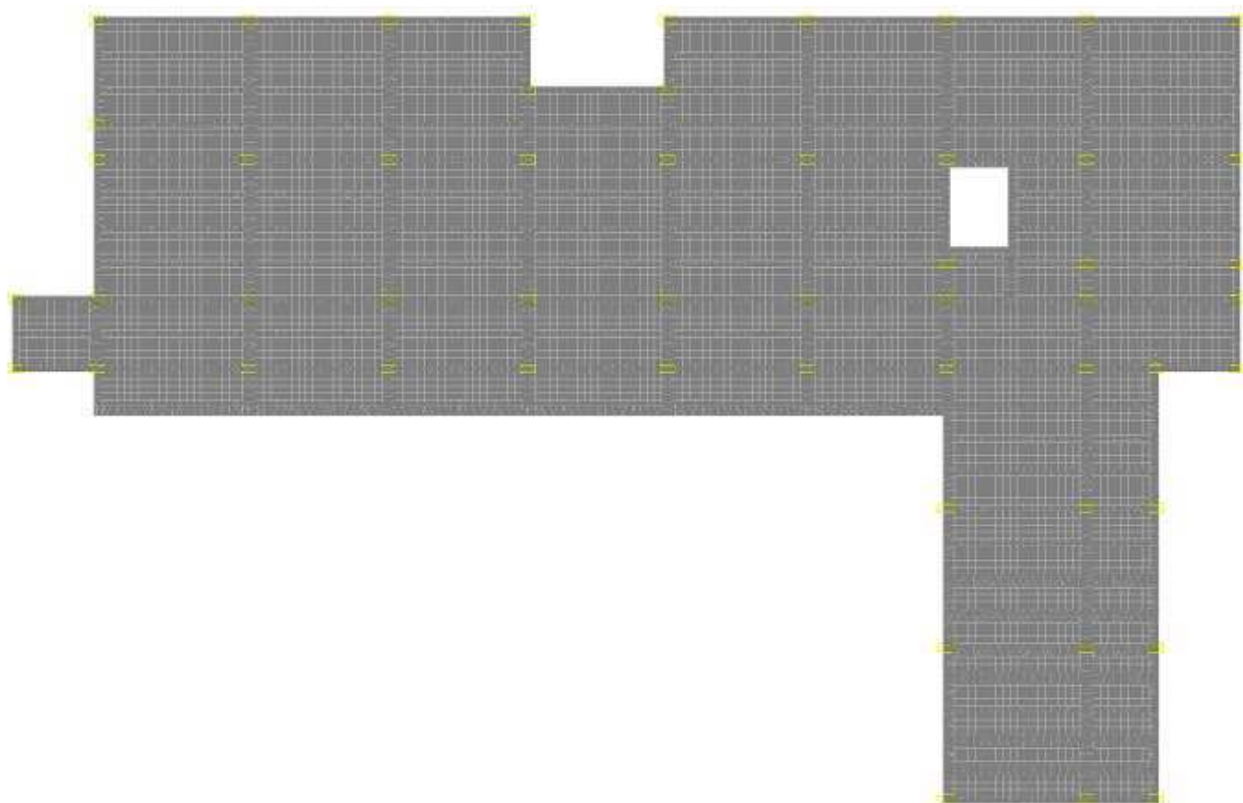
Расчетная схема монолитной плиты перекрытия.
